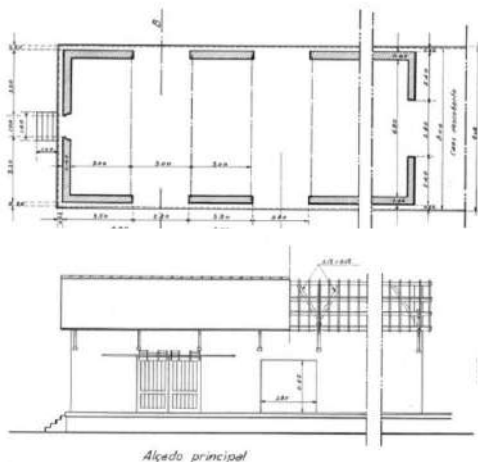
e 2.33 - Planta e alçado principal para um Cais Coberto em alvenaria.³²⁴
